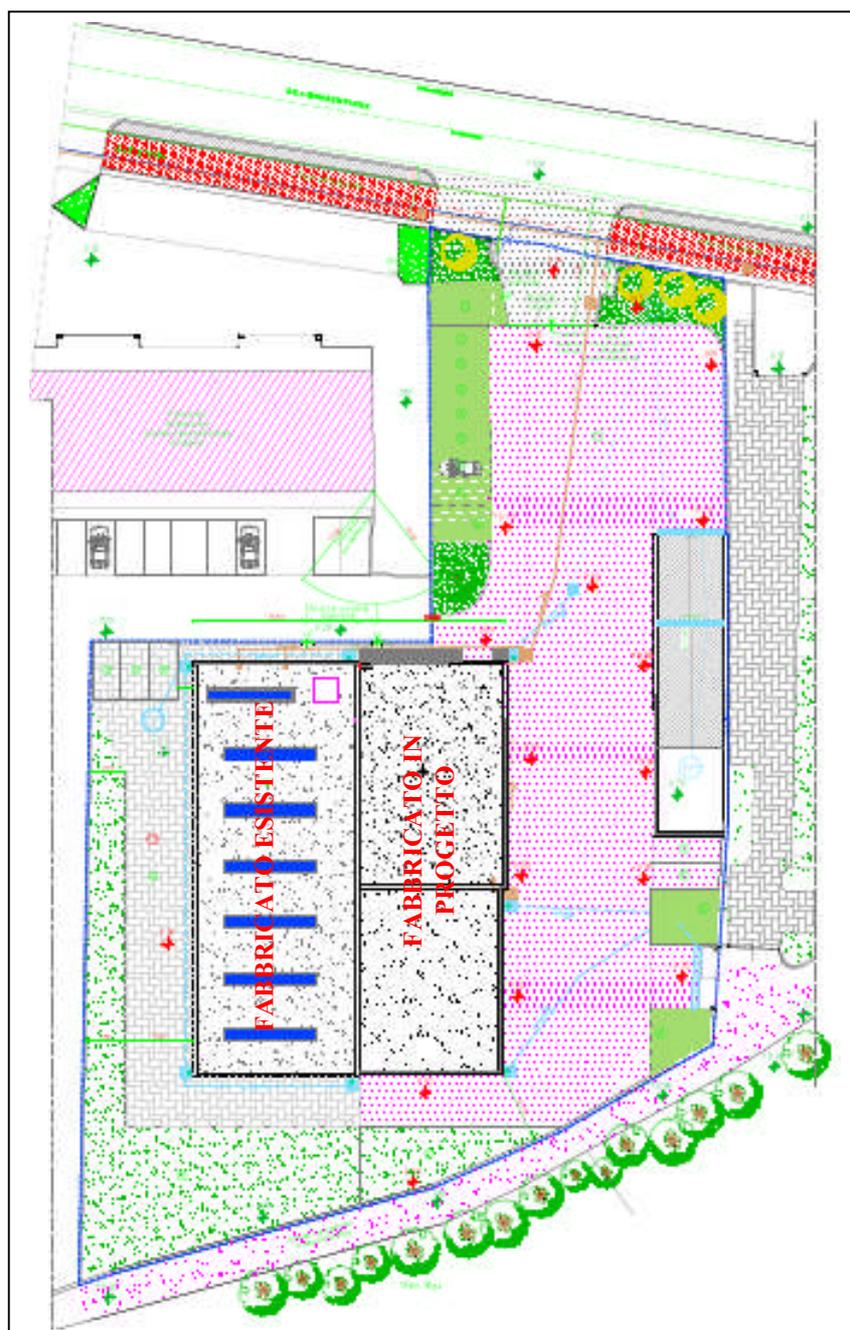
Planimetria generale di progetto – Lotto di intervento
